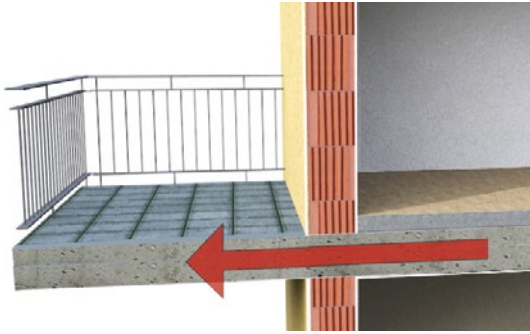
| Massive Wärmebrücke: Durchgehend betonierte Balkonplatte
